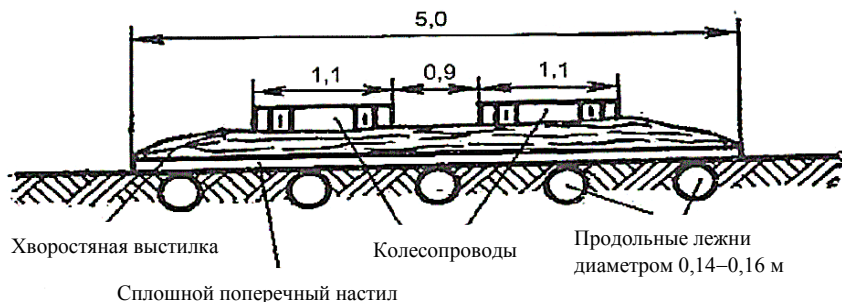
Поперечные профили лесных дорог на болотах с колеевым типом покрытия
